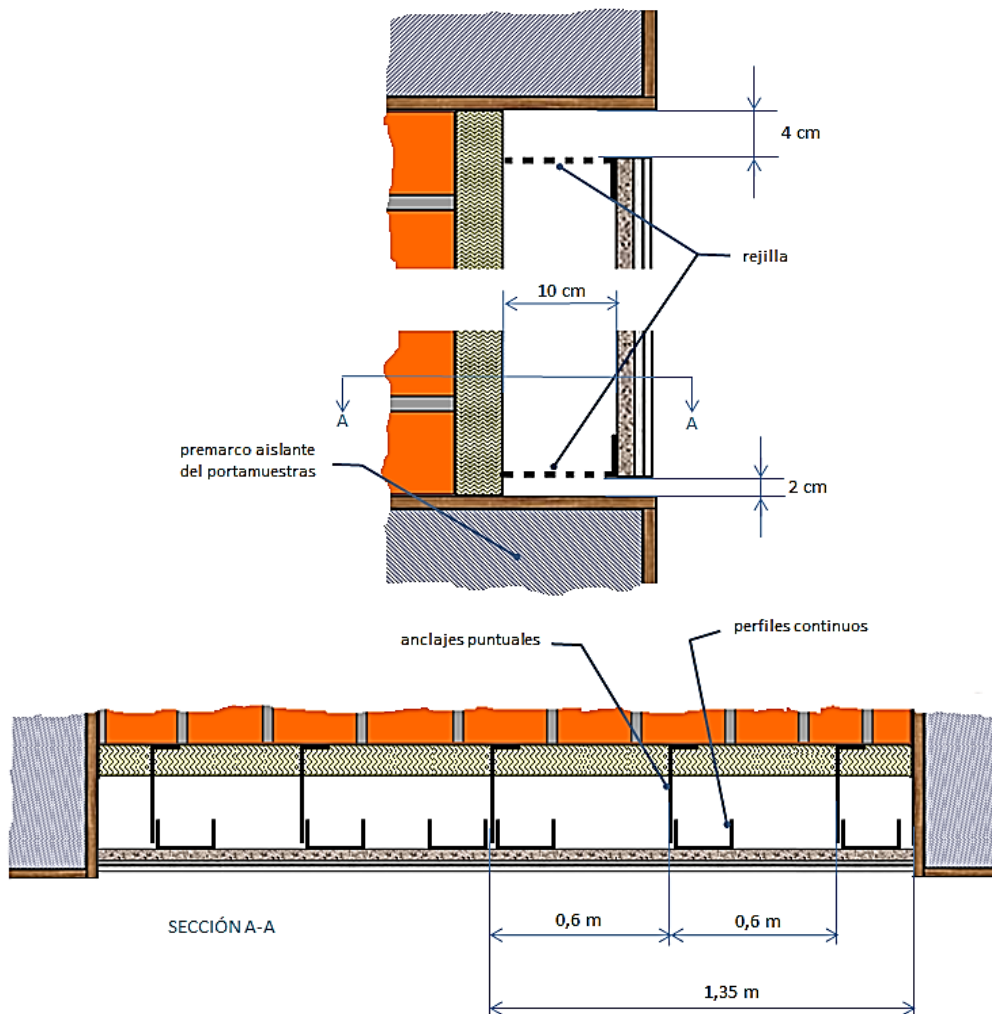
Detalles constructivos de la probeta PASLINK correspondiente a la fachada ventilada ligera
